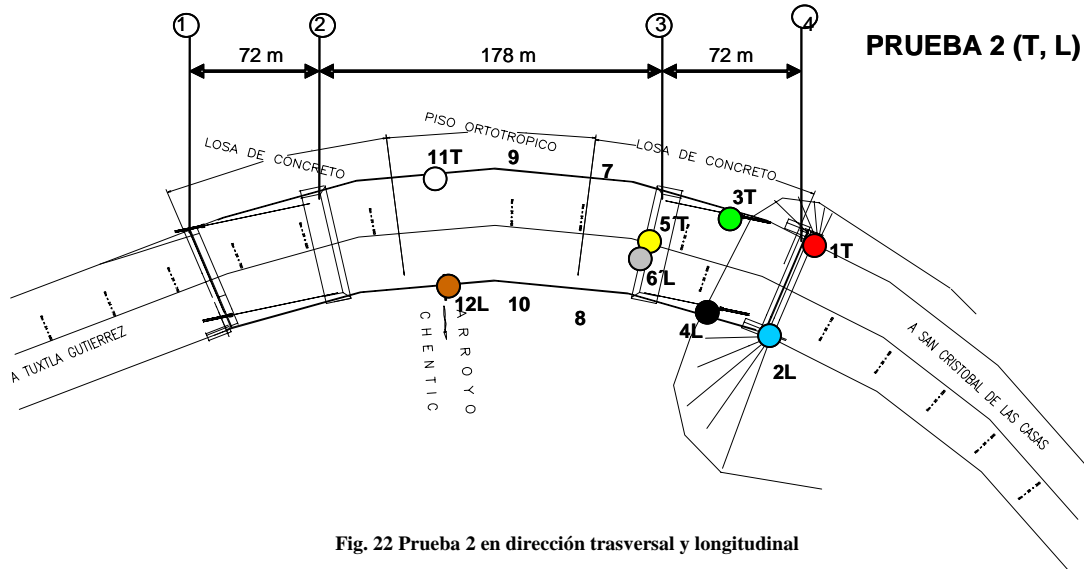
Prueba 2 en dirección trasversal y longitudinal
